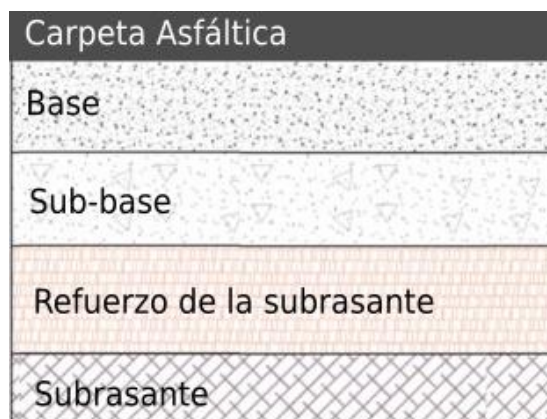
Estructura de pavimento asfáltico (corte transversal)
